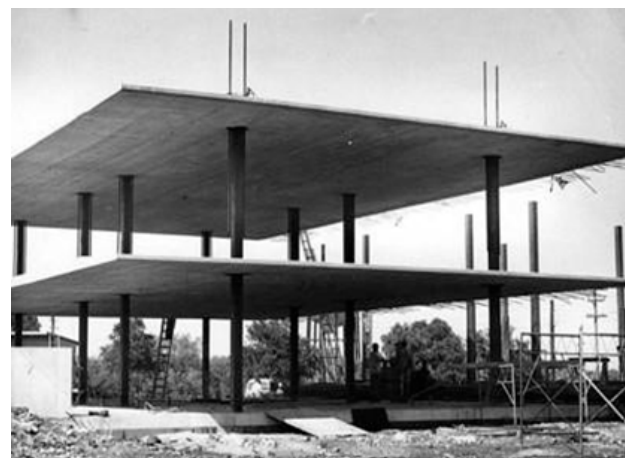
Construcción. ASCE (American Society of Civil Engineers). Pág. 8
